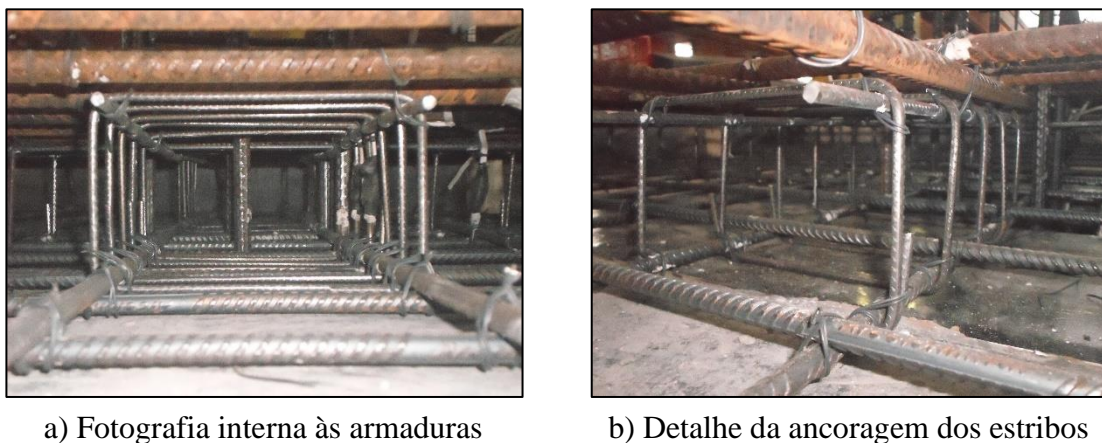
Fotografias da ancoragem dos estribos na laje CA-05.
